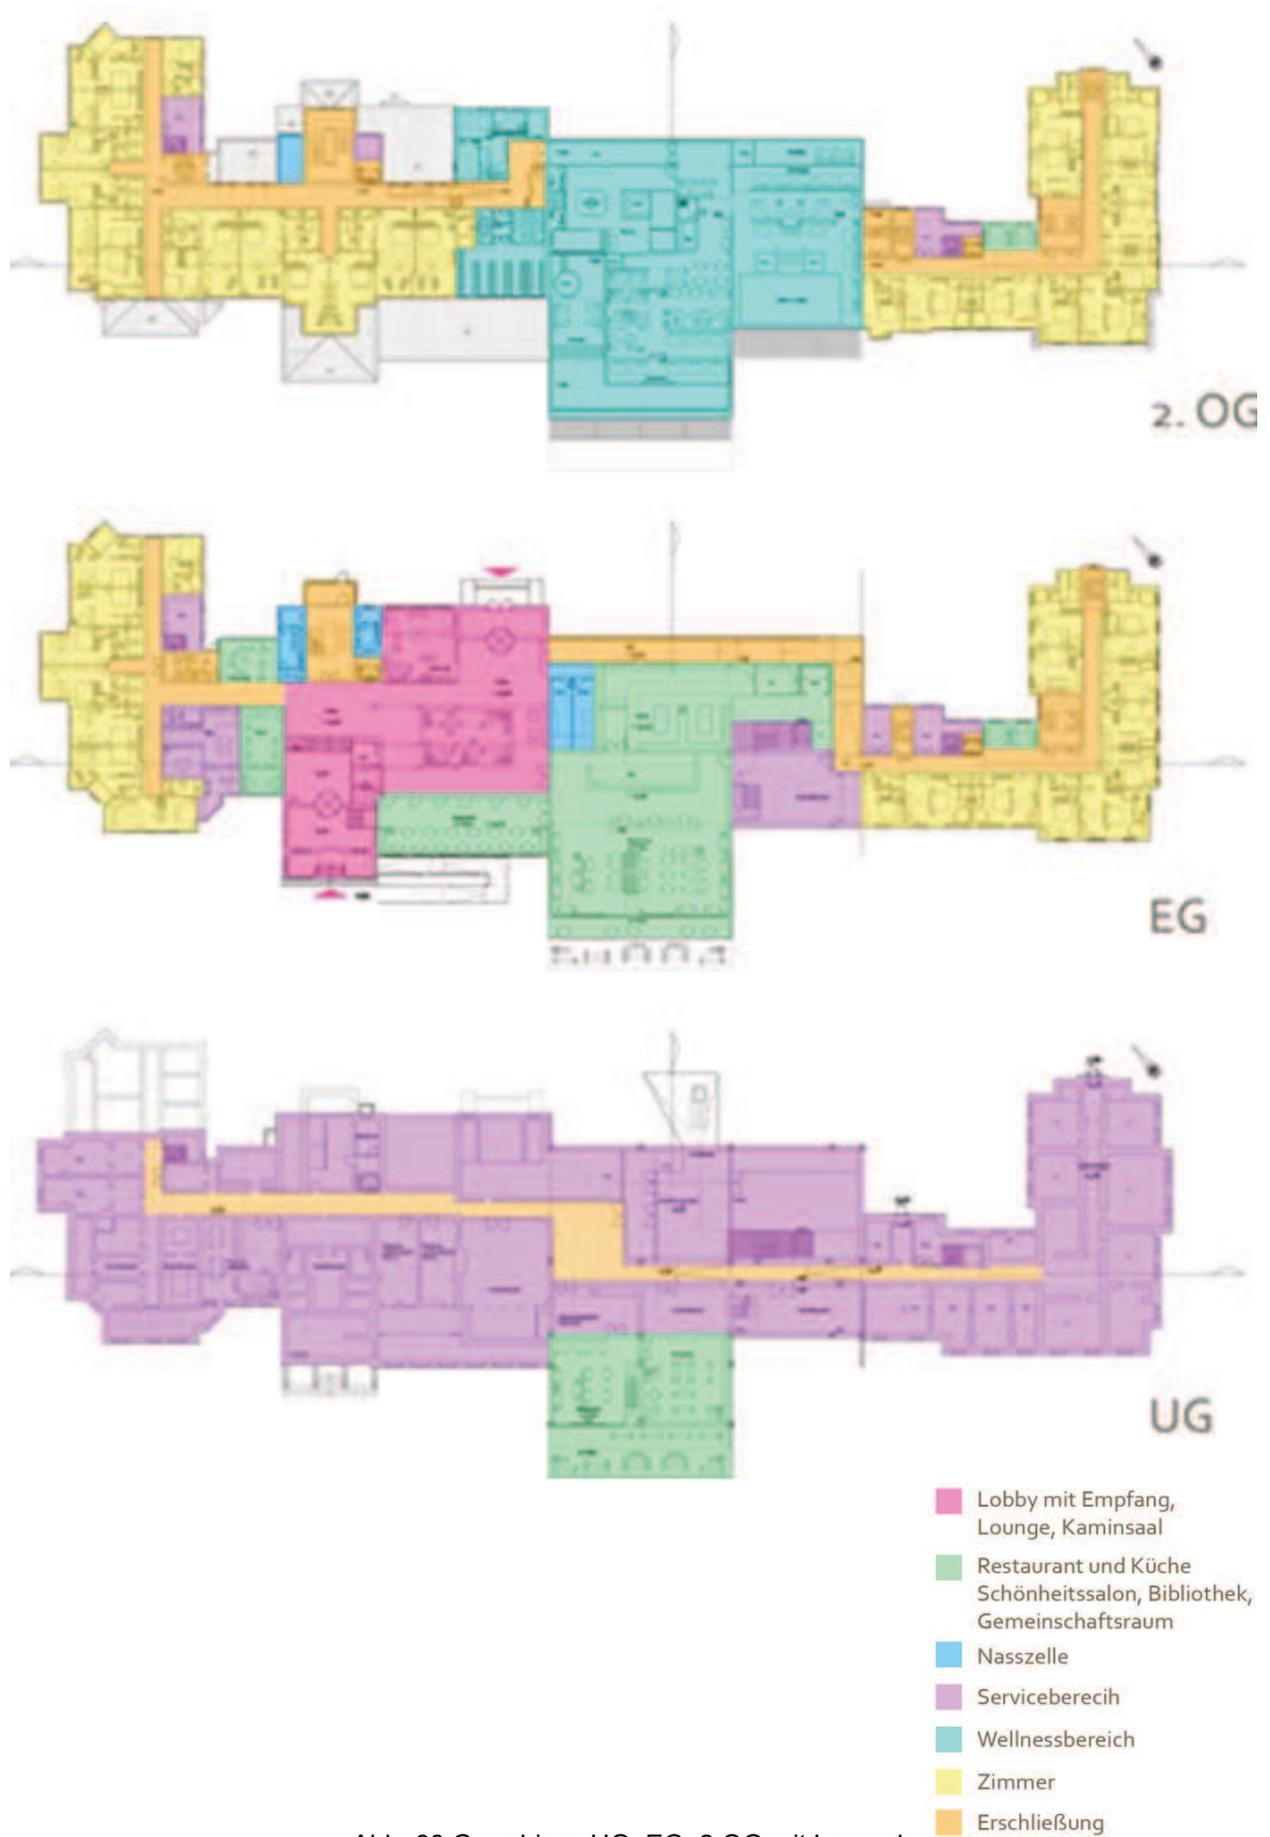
Grundrisse UG, EG, 2.OG mit Legende
